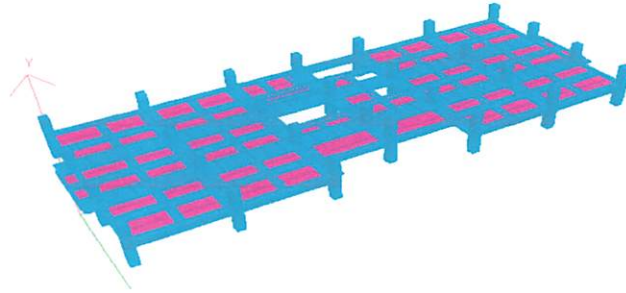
Pemodelan struktur lantai 2 pada STAAD Pro
